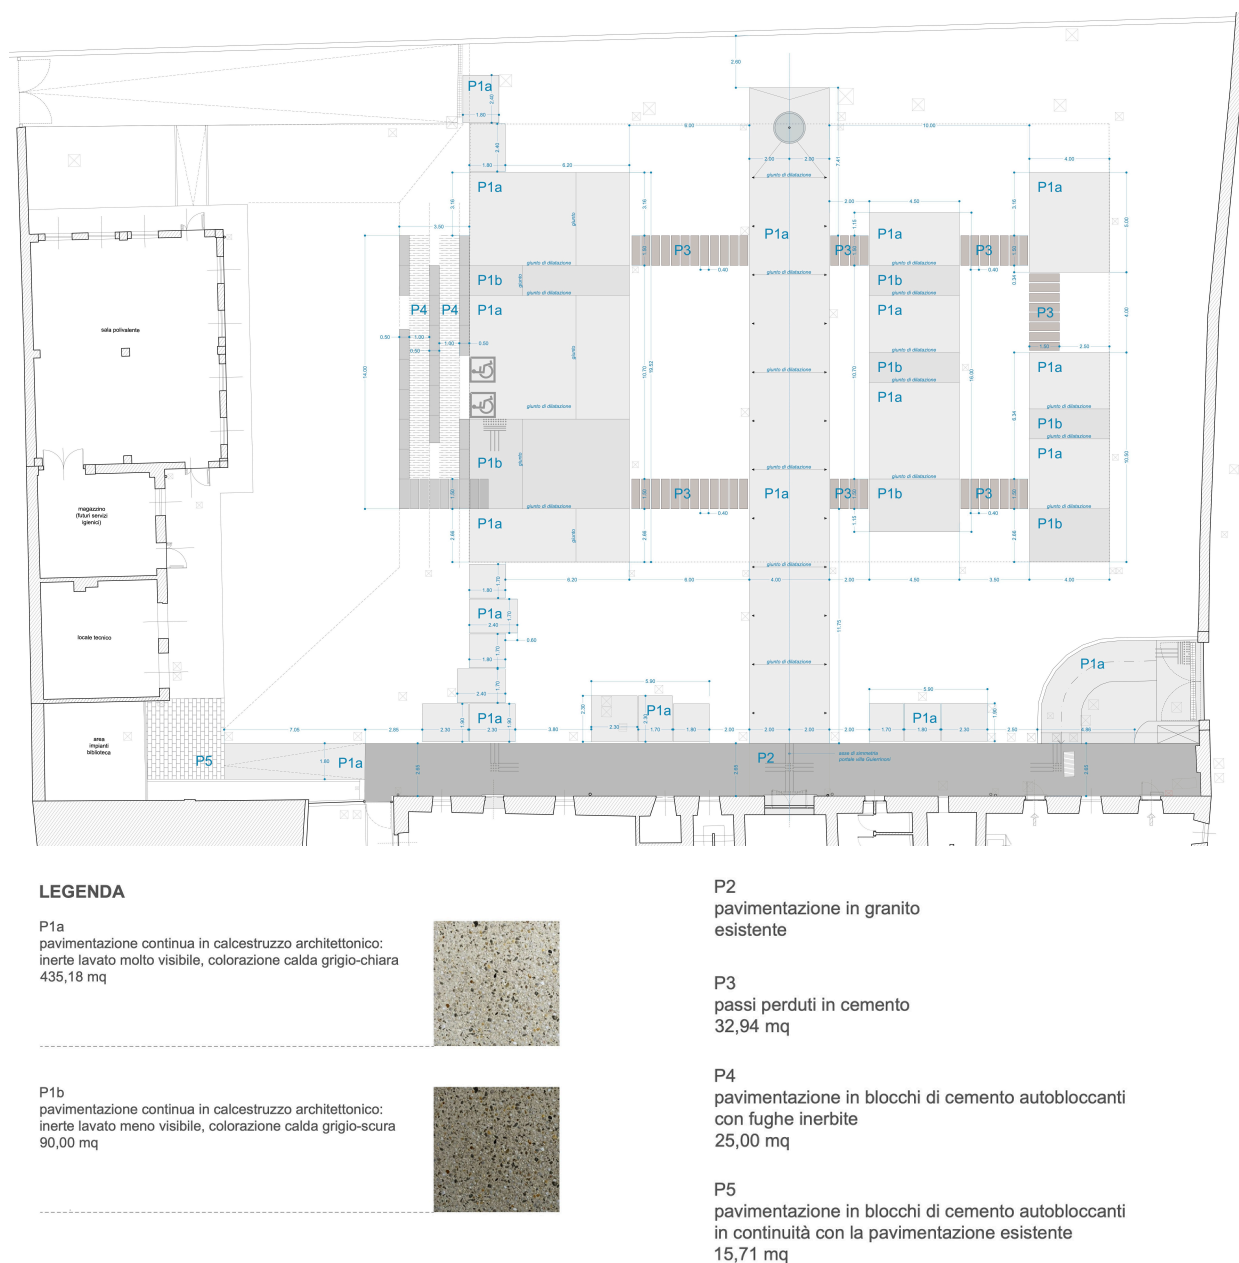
Schema tipologico delle pavimentazioni (estratti dalla tavola T5).
